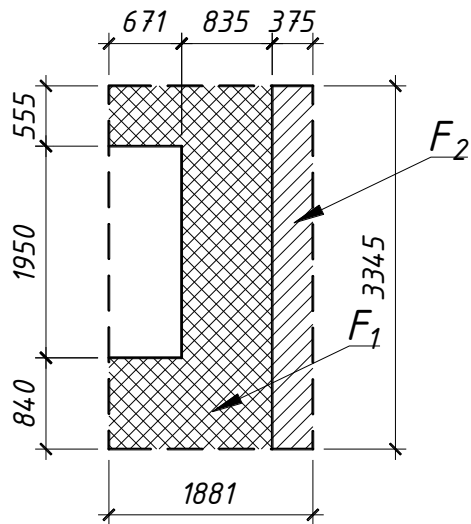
Фрагмент фасаду з розрахунковою ділянкою
